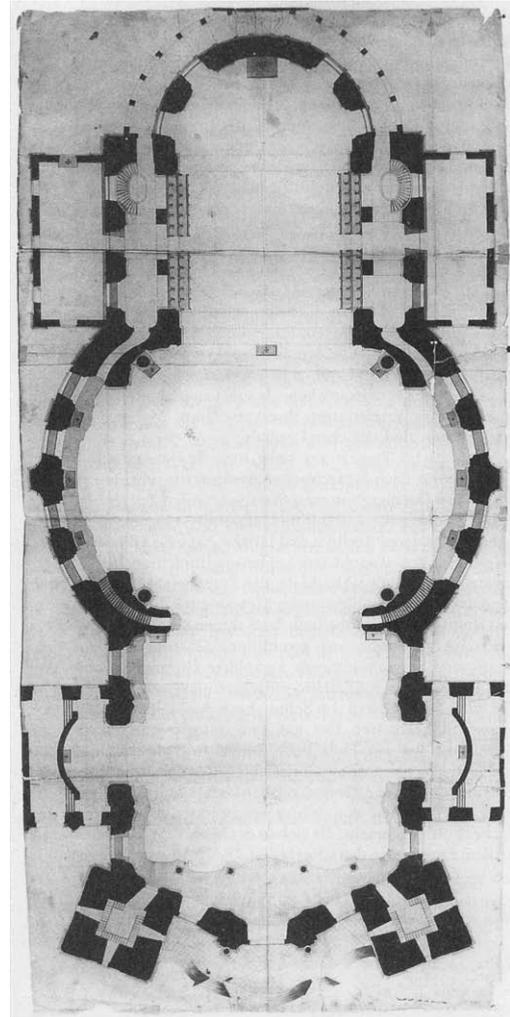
Johann Georg Specht: Grundriss der Klosterkirche Wiblingen, um 1771. Ulm, Staatl. Vermögens- und Hochbauamt (aus: Braig, Wiblingen 2001, Abb.65)
